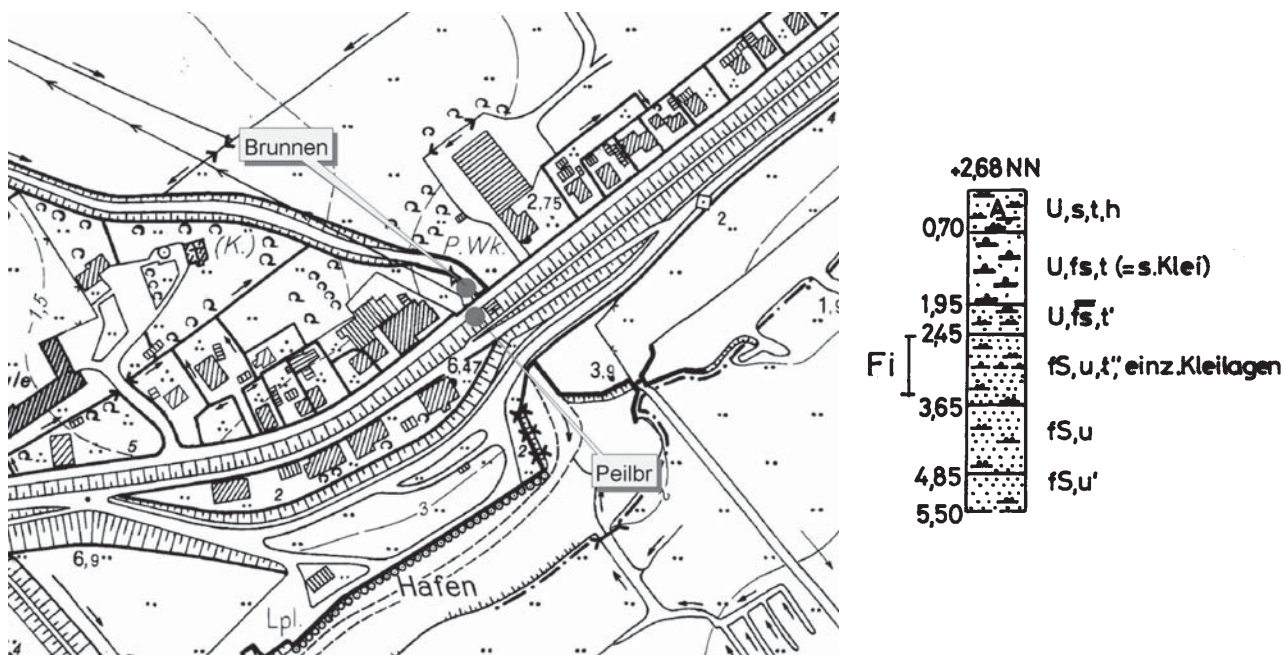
Lageplan mit Bohrprofil am Deichsiel Neufeld
